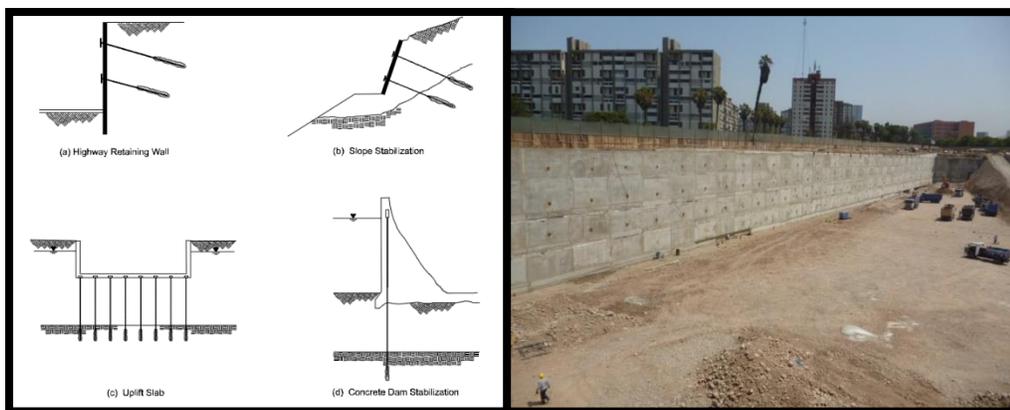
A la izquierda se muestra las diversas aplicaciones de muros anclados (FHWA, 1999, GroundAnchors and AnchoredSystems), a la derecha se muestra el uso de muros anclados en sótanos.
